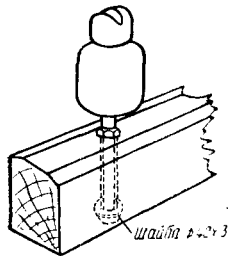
Особо усиленная конструкция крепления провода при двусторонней тяге вниз
